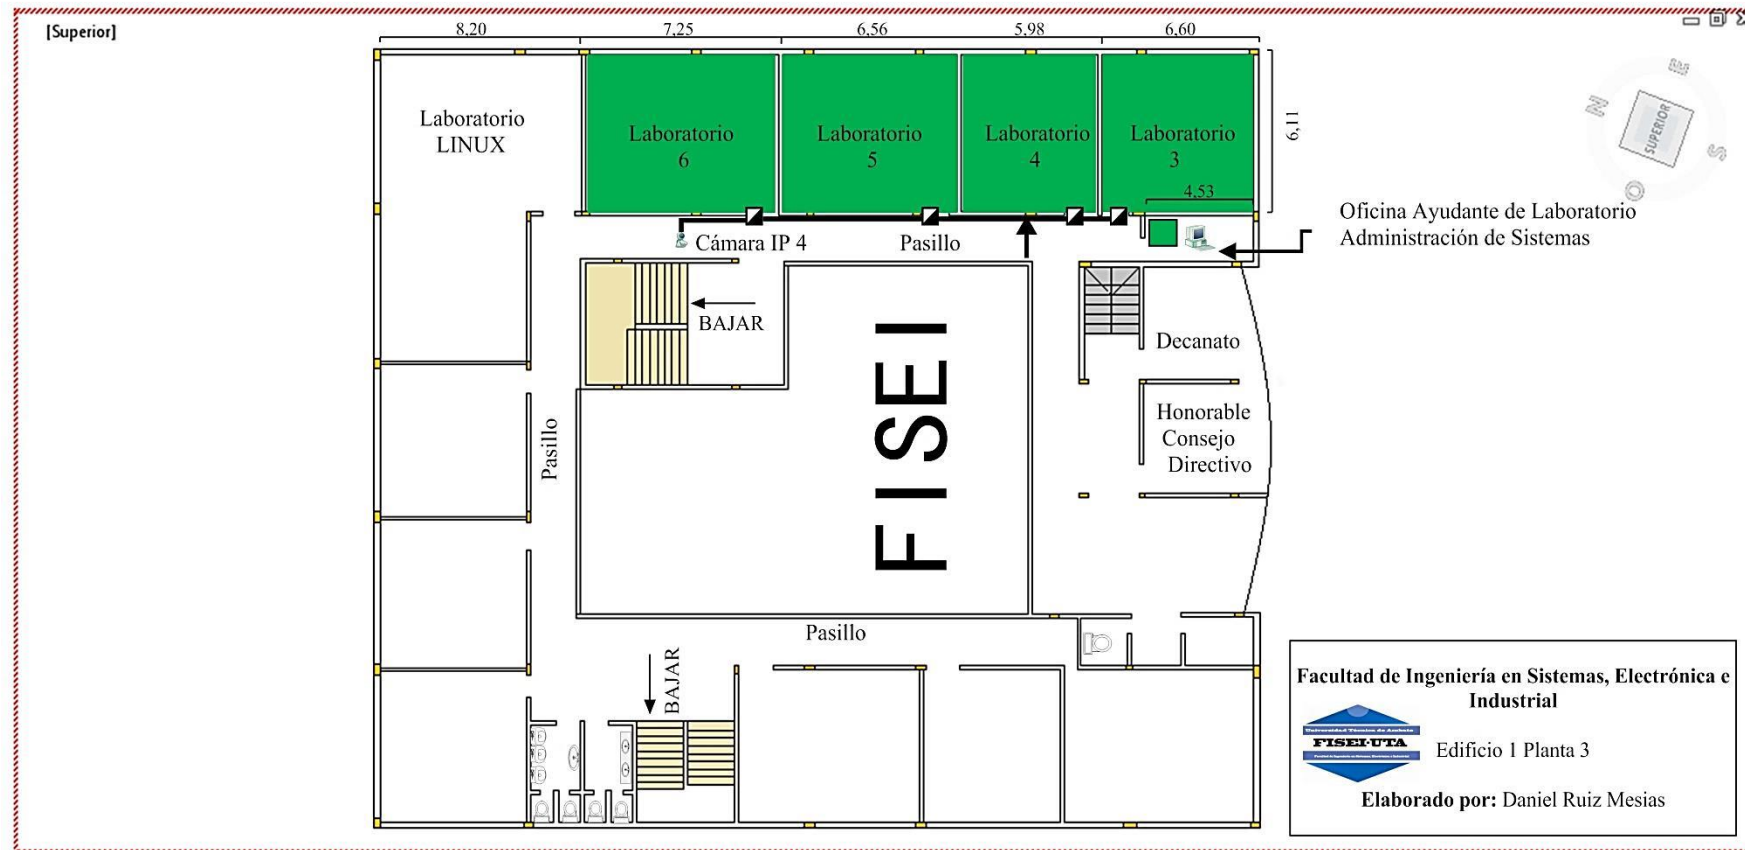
Distribución de elementos y cableado Edificio 1 Planta 3.
